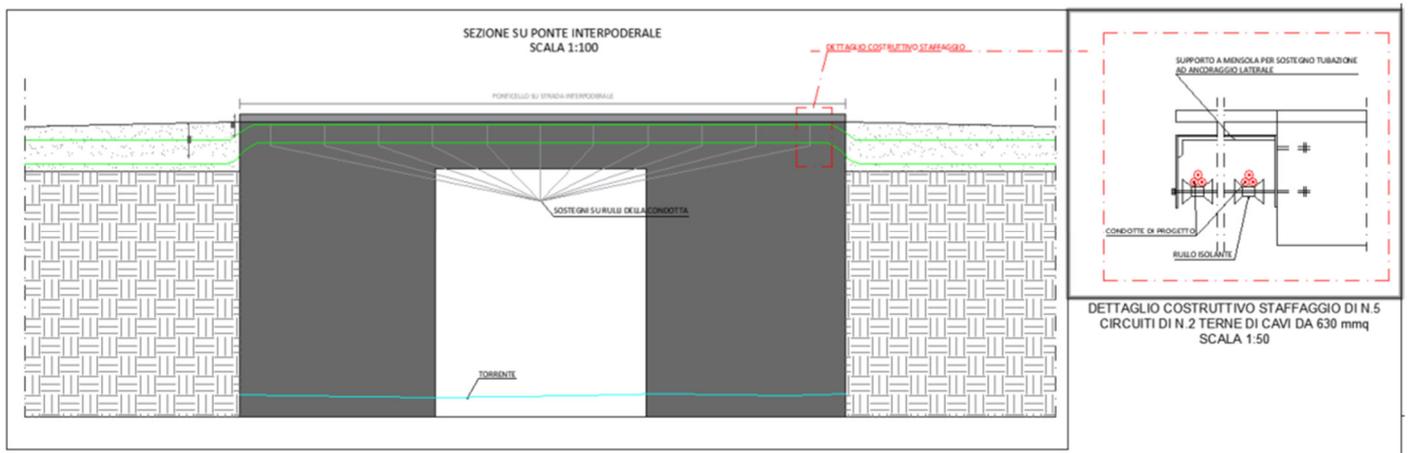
Sezione tipica dello staffaggio dei cavi sulla fiancata di un ponte
